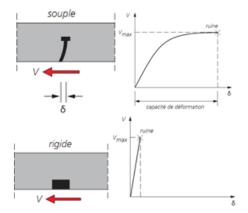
Comportement d'un connecteur souple et d'un connecteur rigide
